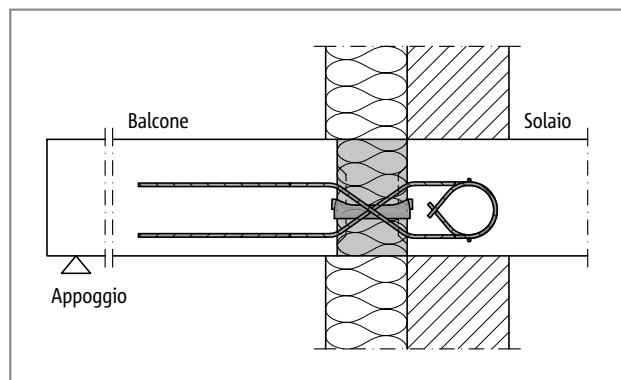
Schöck Isokorb® tipo QXT+QXT: raccordo con sistema di isolamento a cappotto (WDVS)
